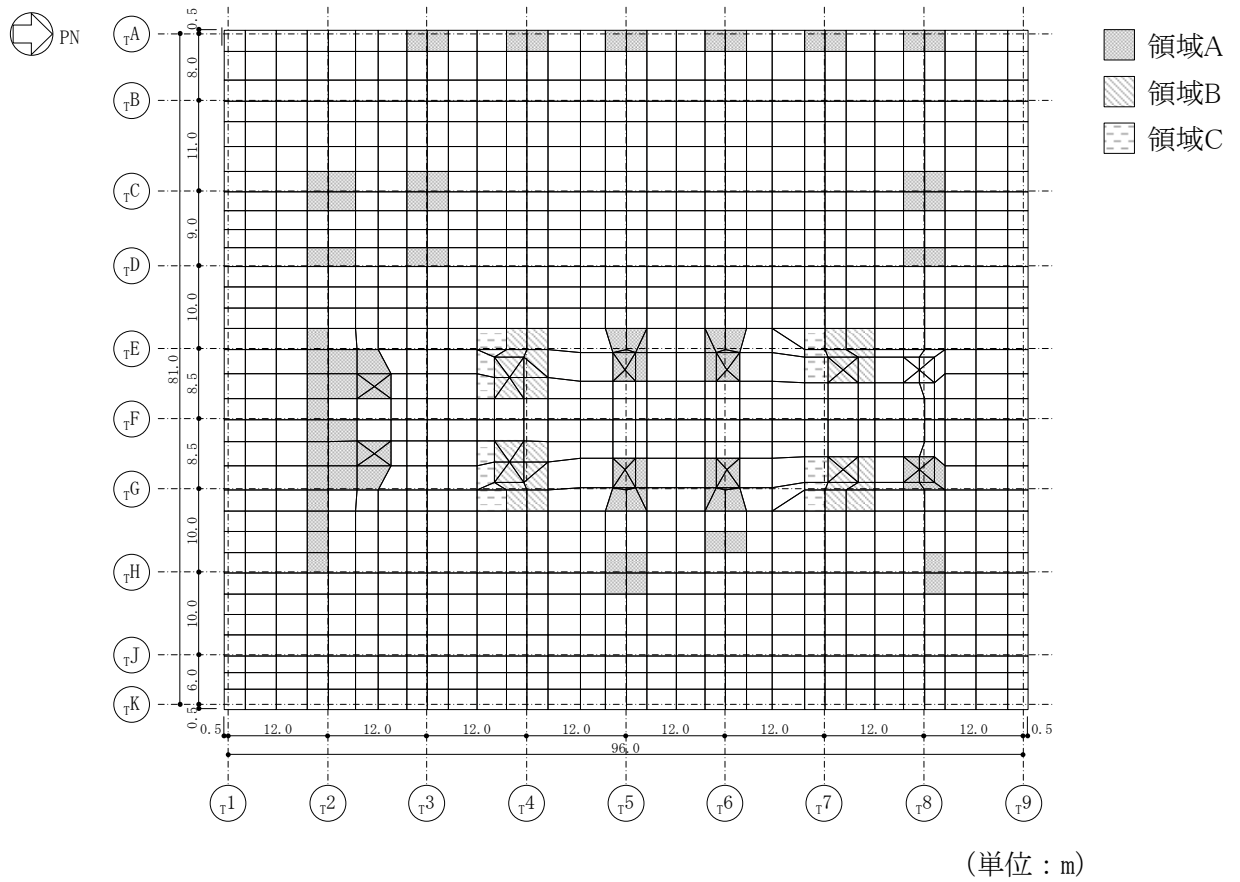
基礎スラブの配筋領域図 (せん断補強筋)
